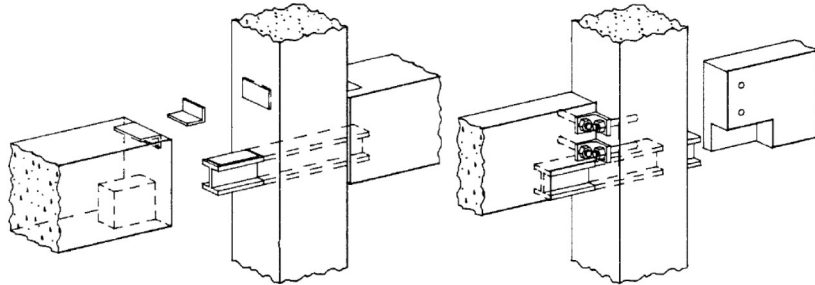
Ligação por consolo metálico (Levy, 2000)
